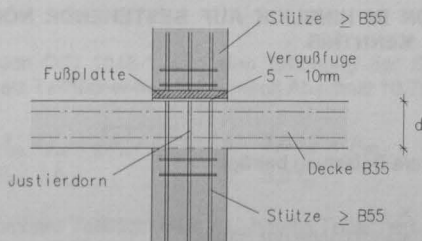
Fertigteilstütze aus hochfestem Beton mit bis OK-Decke durchgehender Bewehrung
